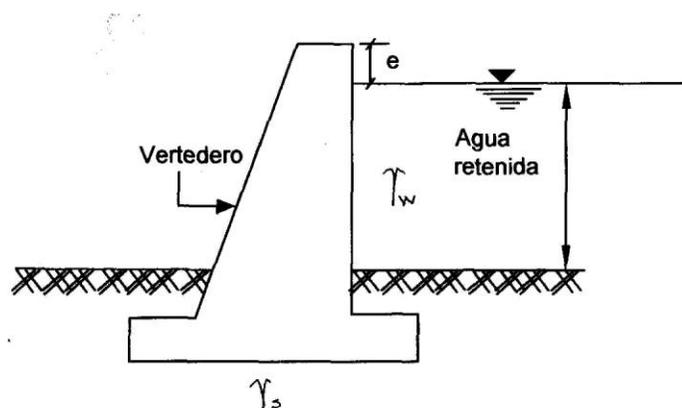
Mecanismo de funcionamiento de muros de concreto reforzado en presas hidráulicas
